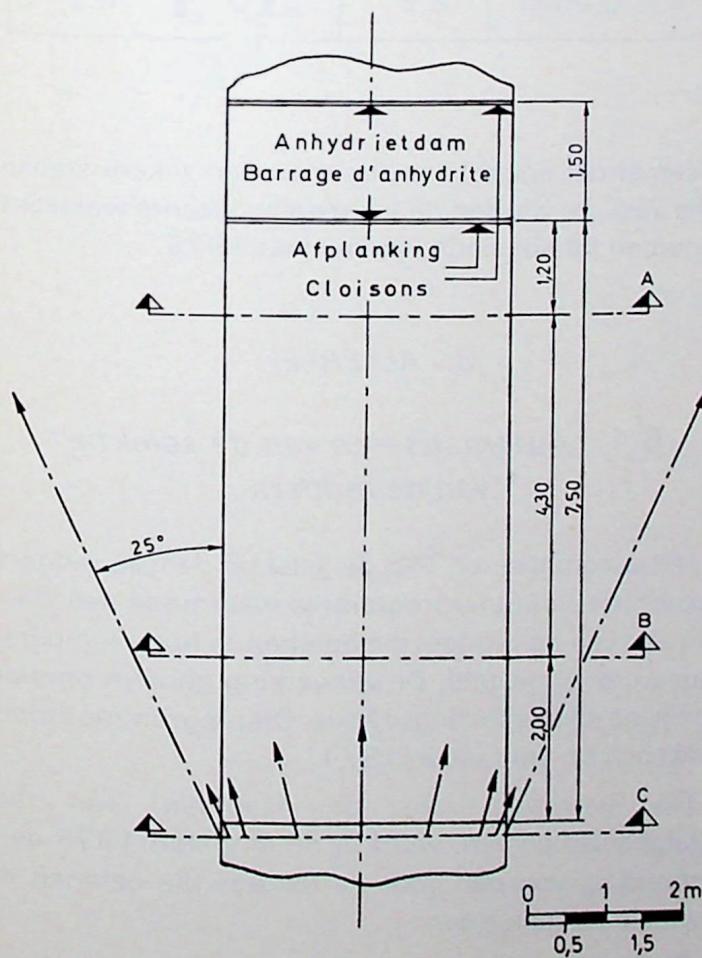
Travaux d'étanchement - Vue en plan (voir aussi fig. 2 A et 2 B)
